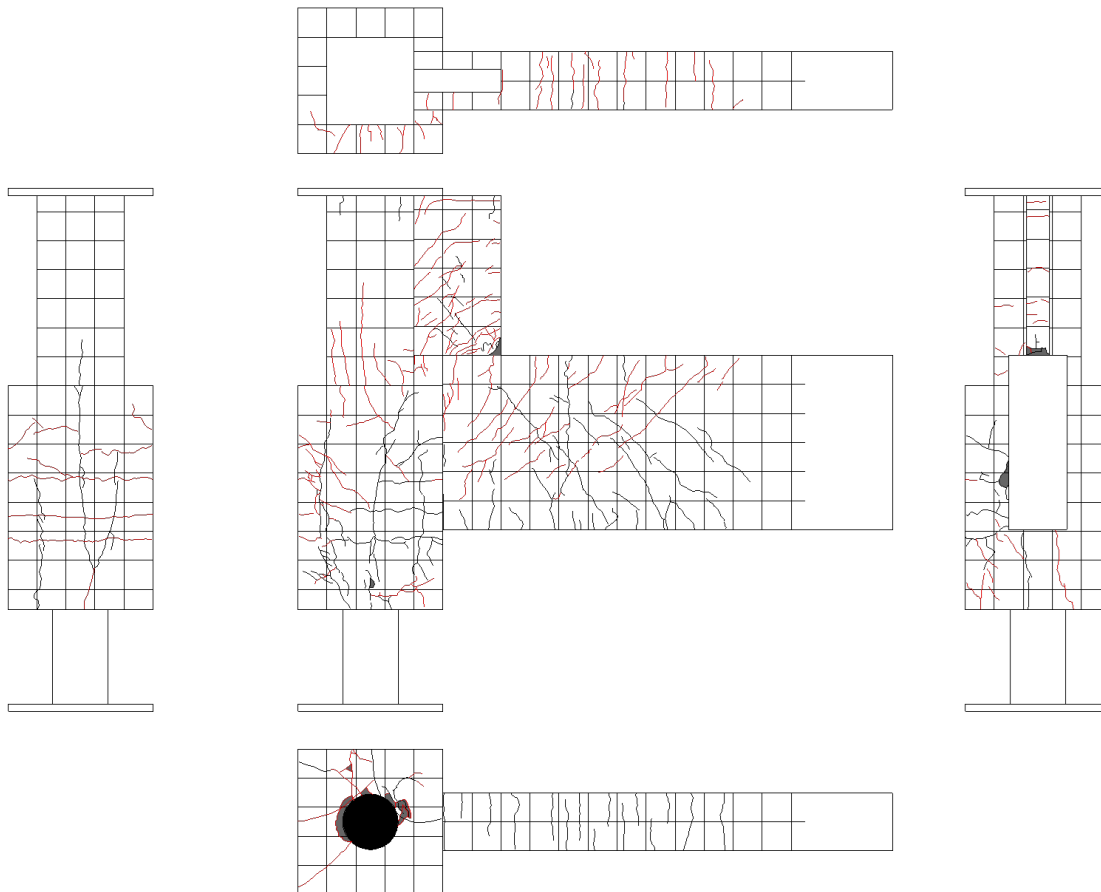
試験体 B-1 ひび割れ状況 (7Cycle)
